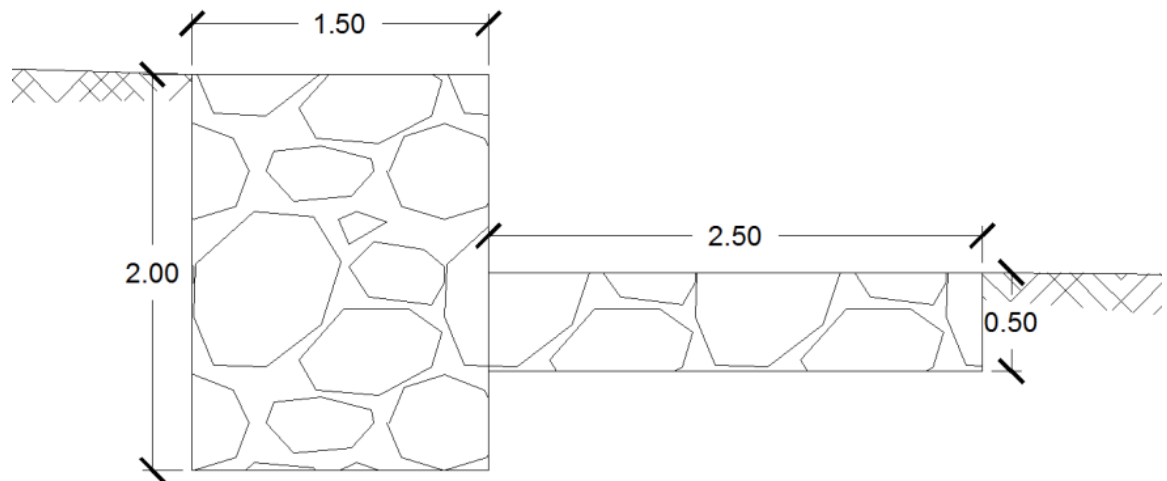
Detalle del muro guardanivel, sin escala.
